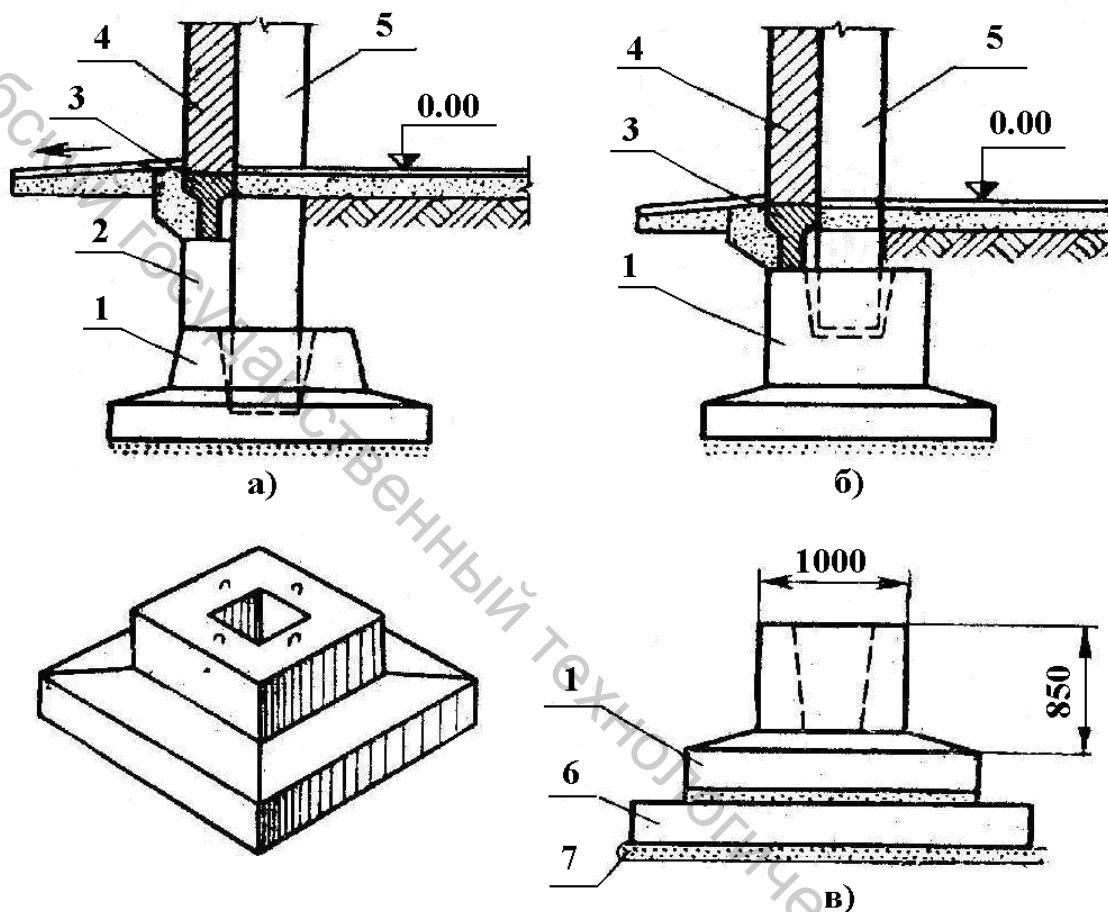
Сборные железобетонные фундаменты стаканного типа под колонны (а – стаканного типа; б – с повышенным стаканом; в – составной фундамент): 1 – фундамент (башмак); 2 – бетонный столбик; 3 – фундаментная балка; 4 – самонесущая стена; 5 – колонна; 6 – плита; 7 – бетонная подготовка)
